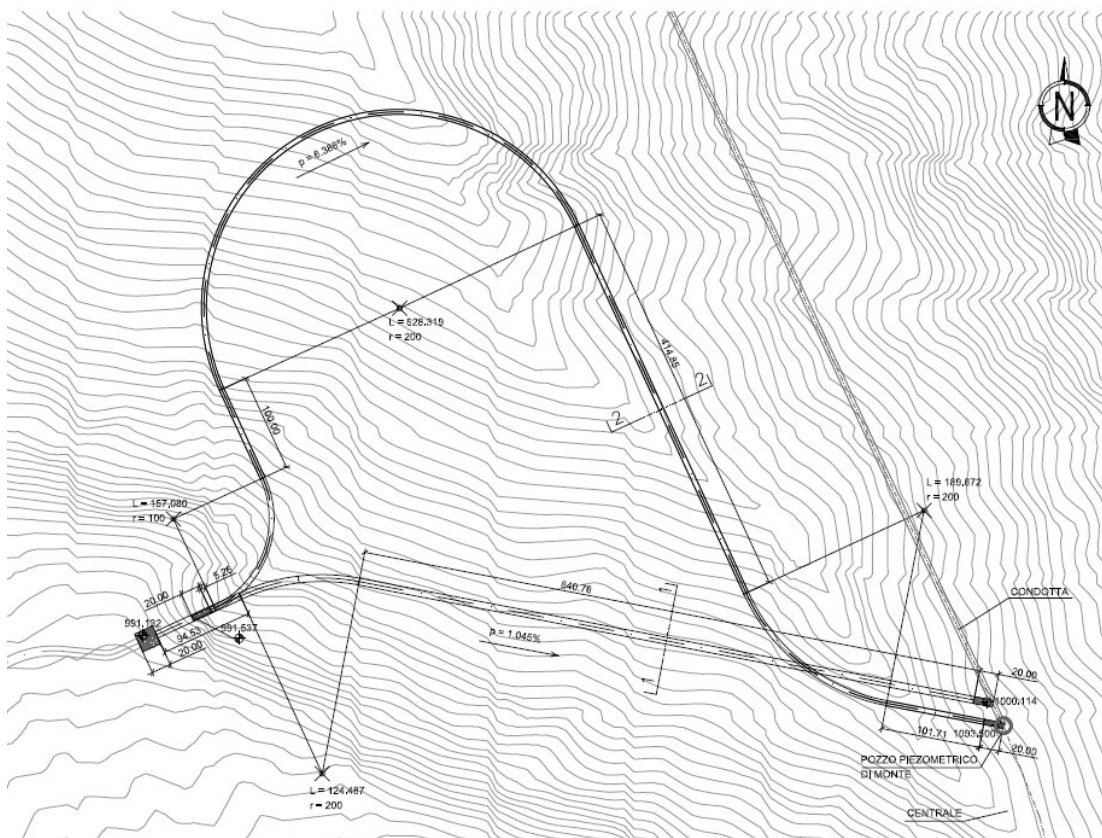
Pianta Galleria Di Accesso Al Pozzo Piezometrico Di Monte
